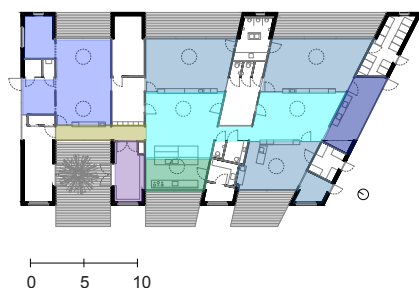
Planta y zonificación Escuela Infantil Urtxintxa. Elaboración propia.
